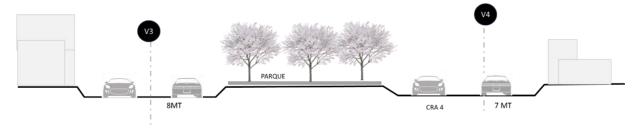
perfiles existentes desde una perspectiva planimétrica Fuente: autor
